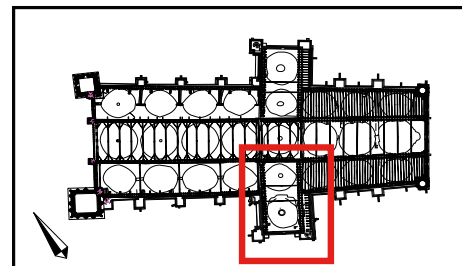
Charpente du bras sud, plan et coupe longitudinale (relevé et DAO : F. E.).
